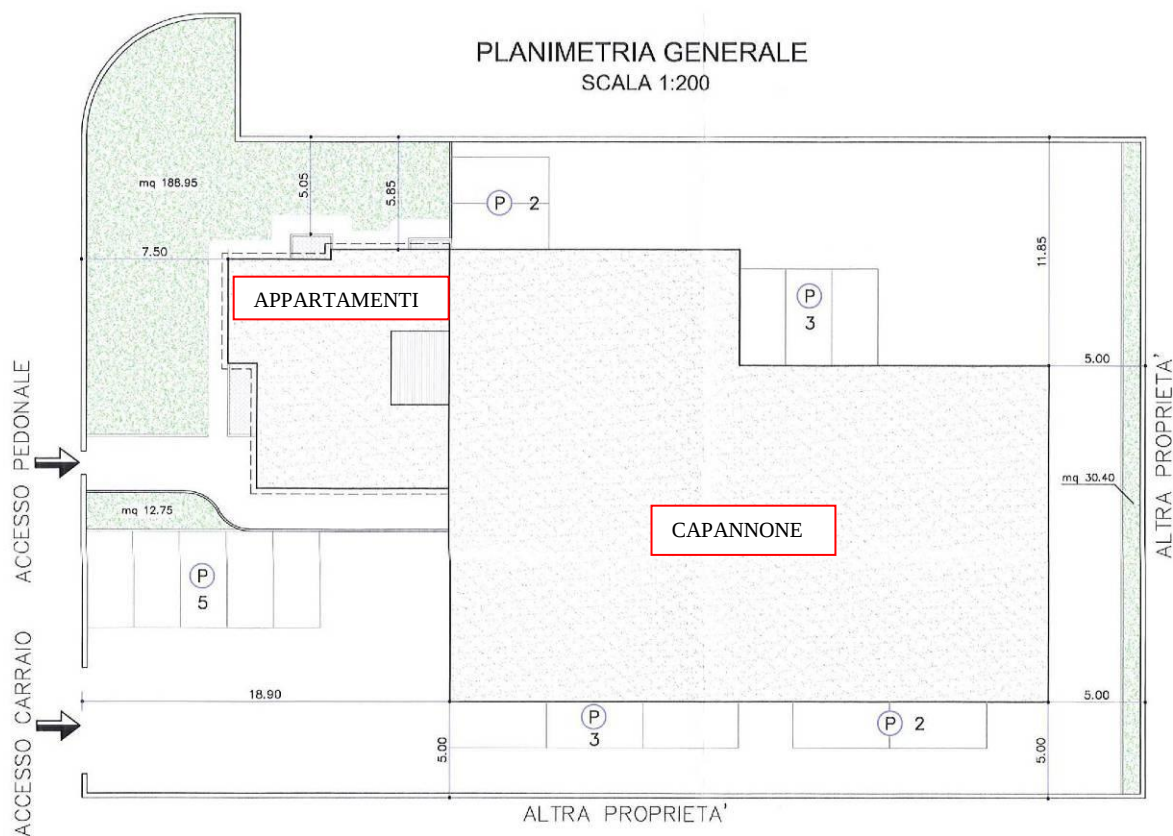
Estratto tavola DIA 818/08 – Planimetria Generale
